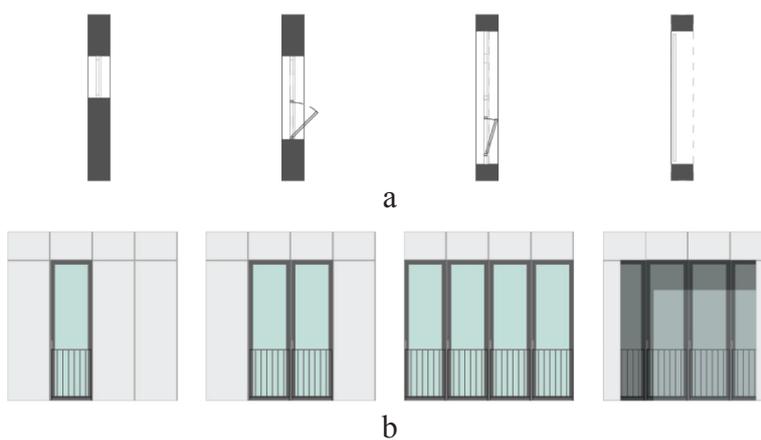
Модуль стены: а – в плане, б – на фасаде
